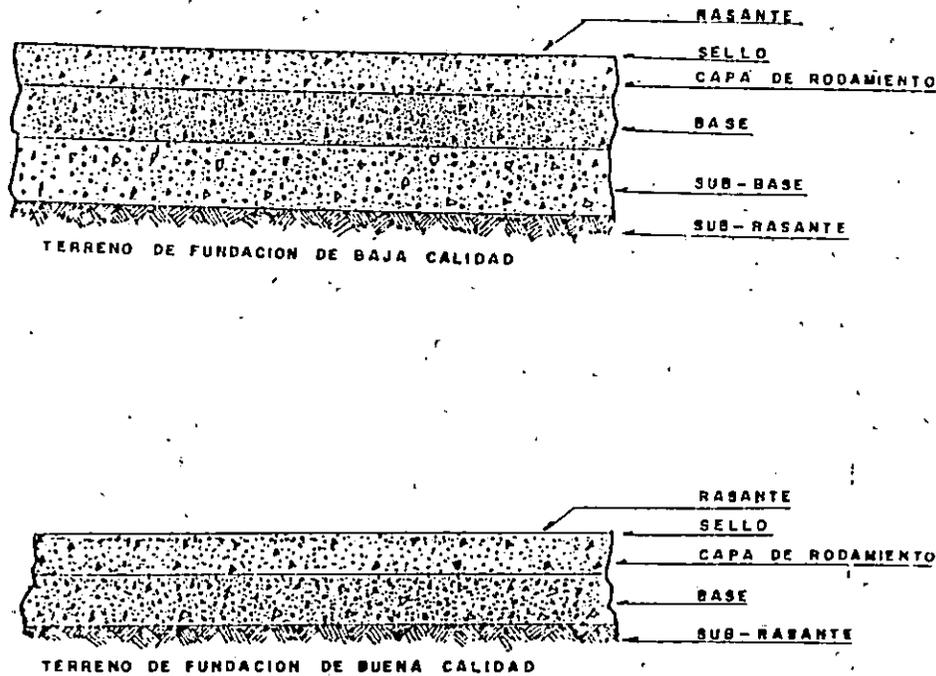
Estructura del pavimento asfaltico Sub-rasante
